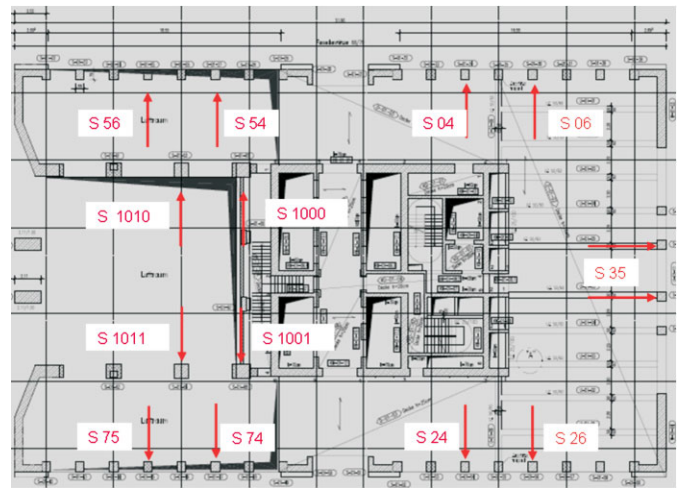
Stützenstränge mit hochfestem Bewehrungsstahl
